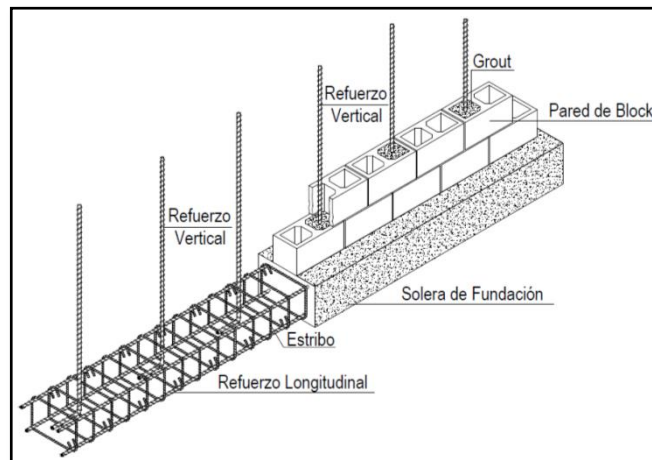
Esquema de solera de fundación de concreto reforzado cargado por una pared de bloque de concreto
